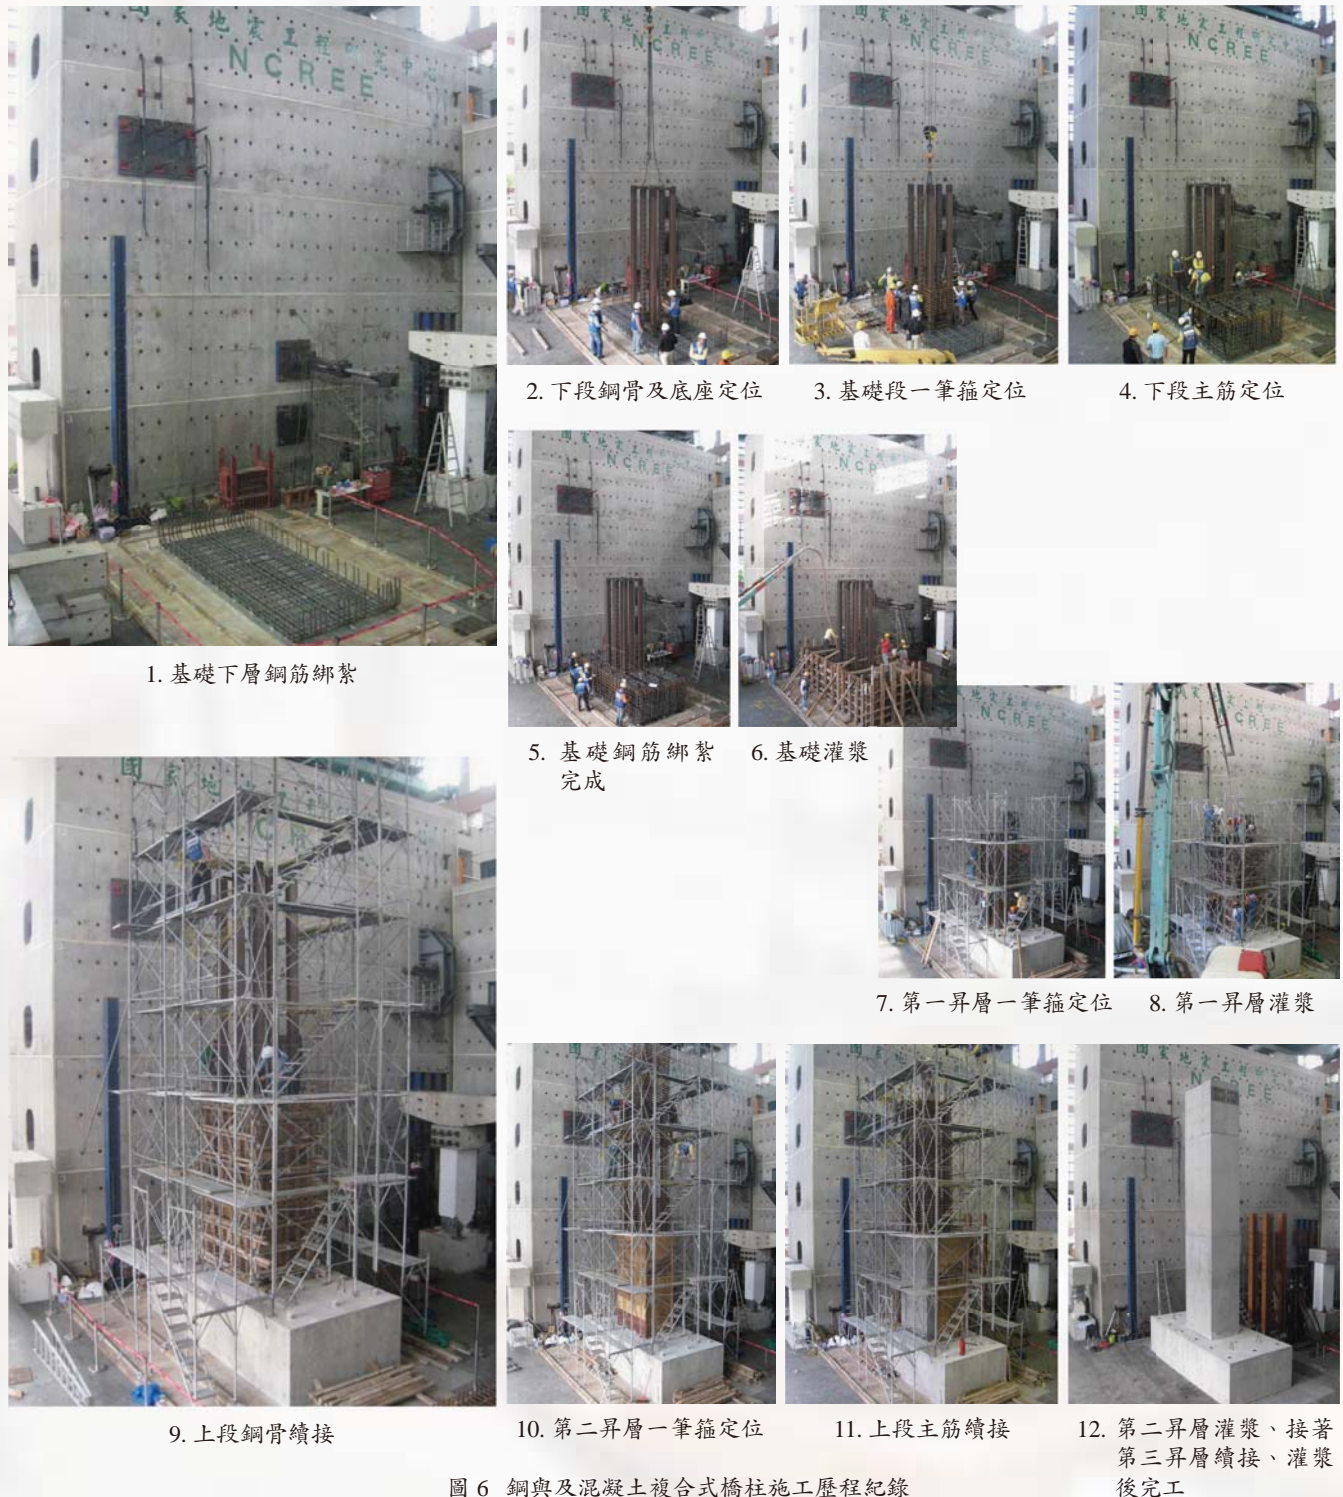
鋼與混凝土複合式橋柱施工歷程紀錄
